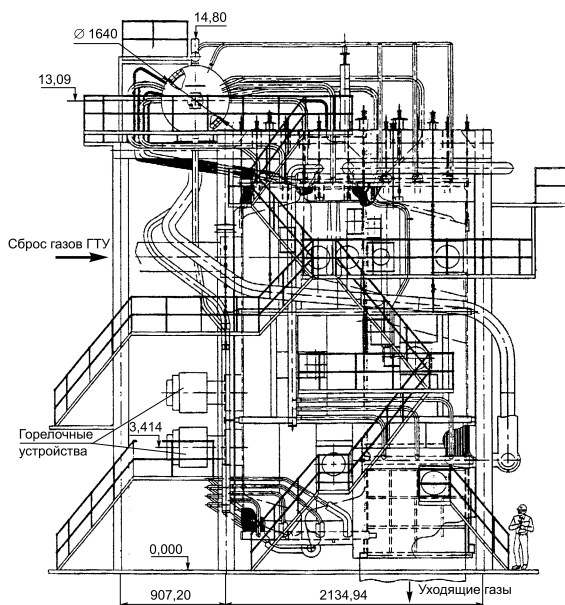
Общая компоновка и схема газоздухопроводов парового котла-утилизатора Е-50-0,7-260Г [21]:
